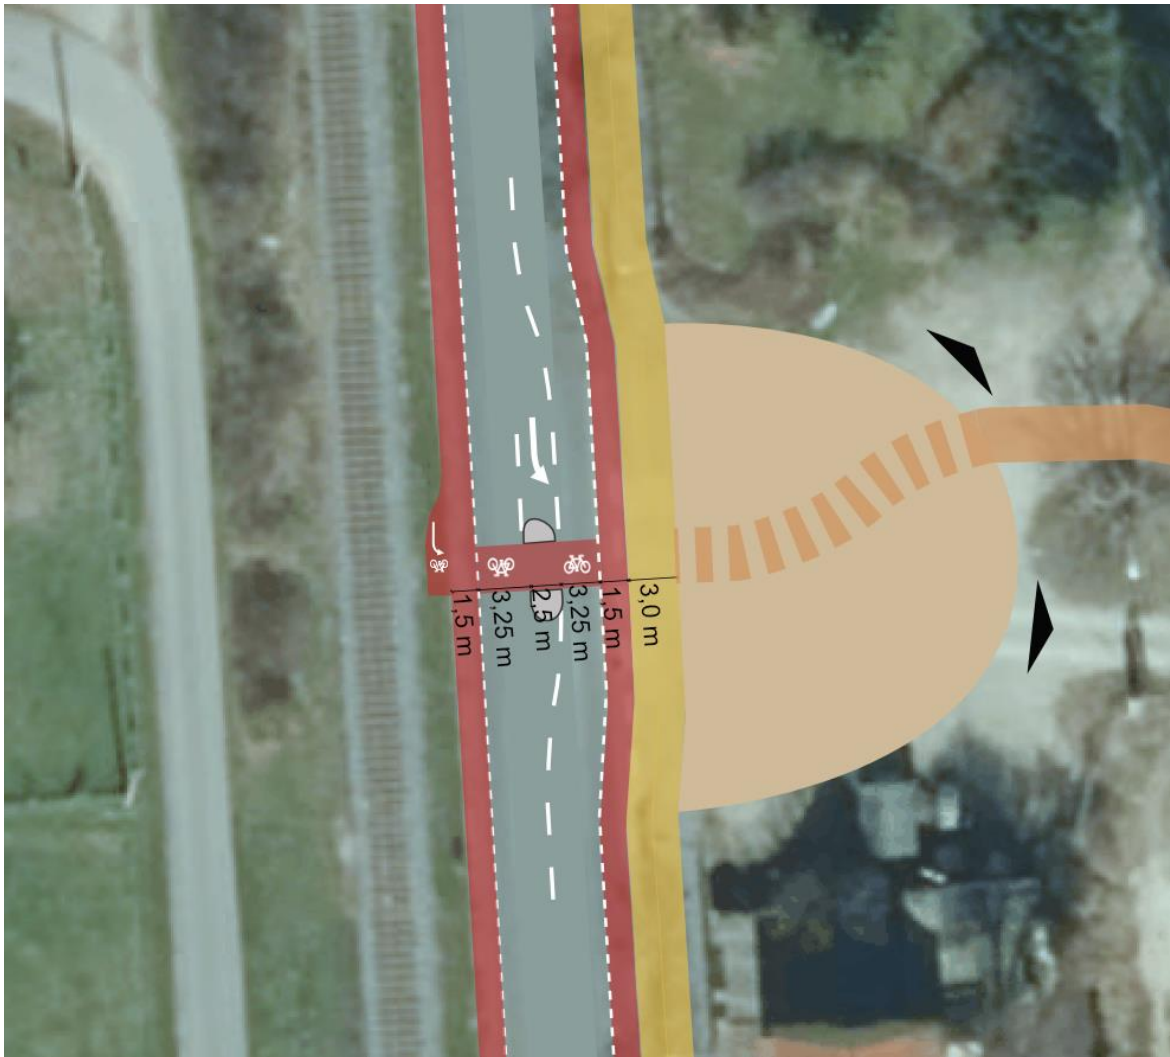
Lageplan für Schutzstreifen auf der Bahnhofstraße mit Querungsanlage zum sicheren Erreichen der Dreibrückenwegs
